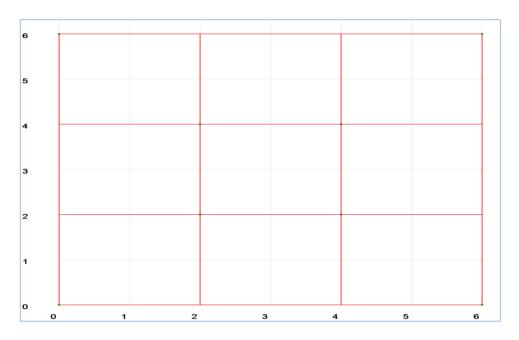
Planta de la Malla y los perfiles Aspix para ρ 1=120 Ω-m
